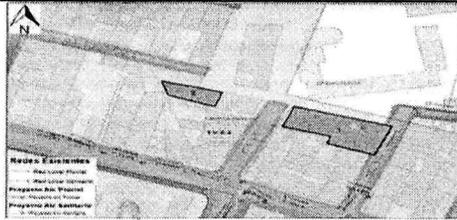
Redes alcantarillado pluvial existentes. Fuente: SIGUE EAAB
